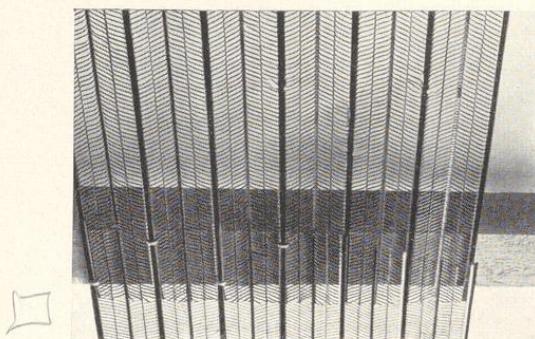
und 827. Befestigung des Rippenstreckmetalls an Holzbalken mit Nägeln und Krampen
